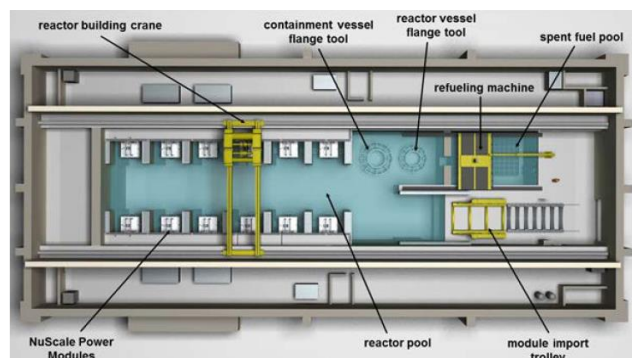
Vista en planta de la instalación NuScale (Doyle & Ingersoll, 2016)
